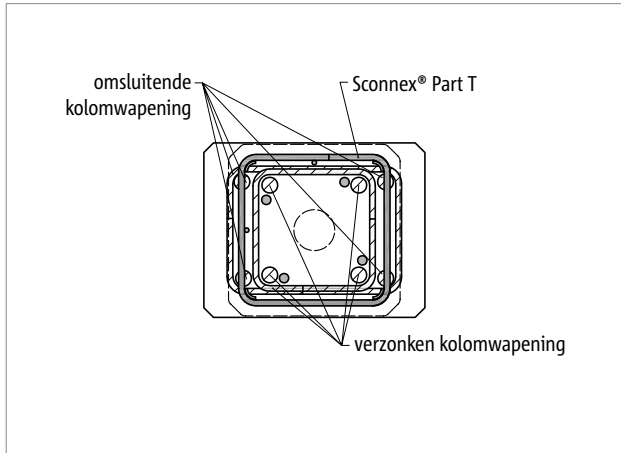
Schöck Sconnex® type P: Wapening in zone 1 - dwarsdoorsnede van de kolom
